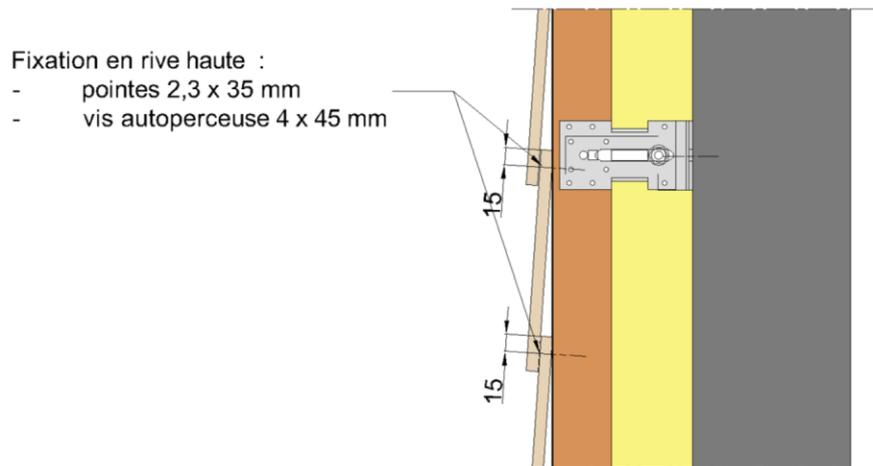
Fixation Rive haute de la lame CEDRAL LAP pose horizontale
